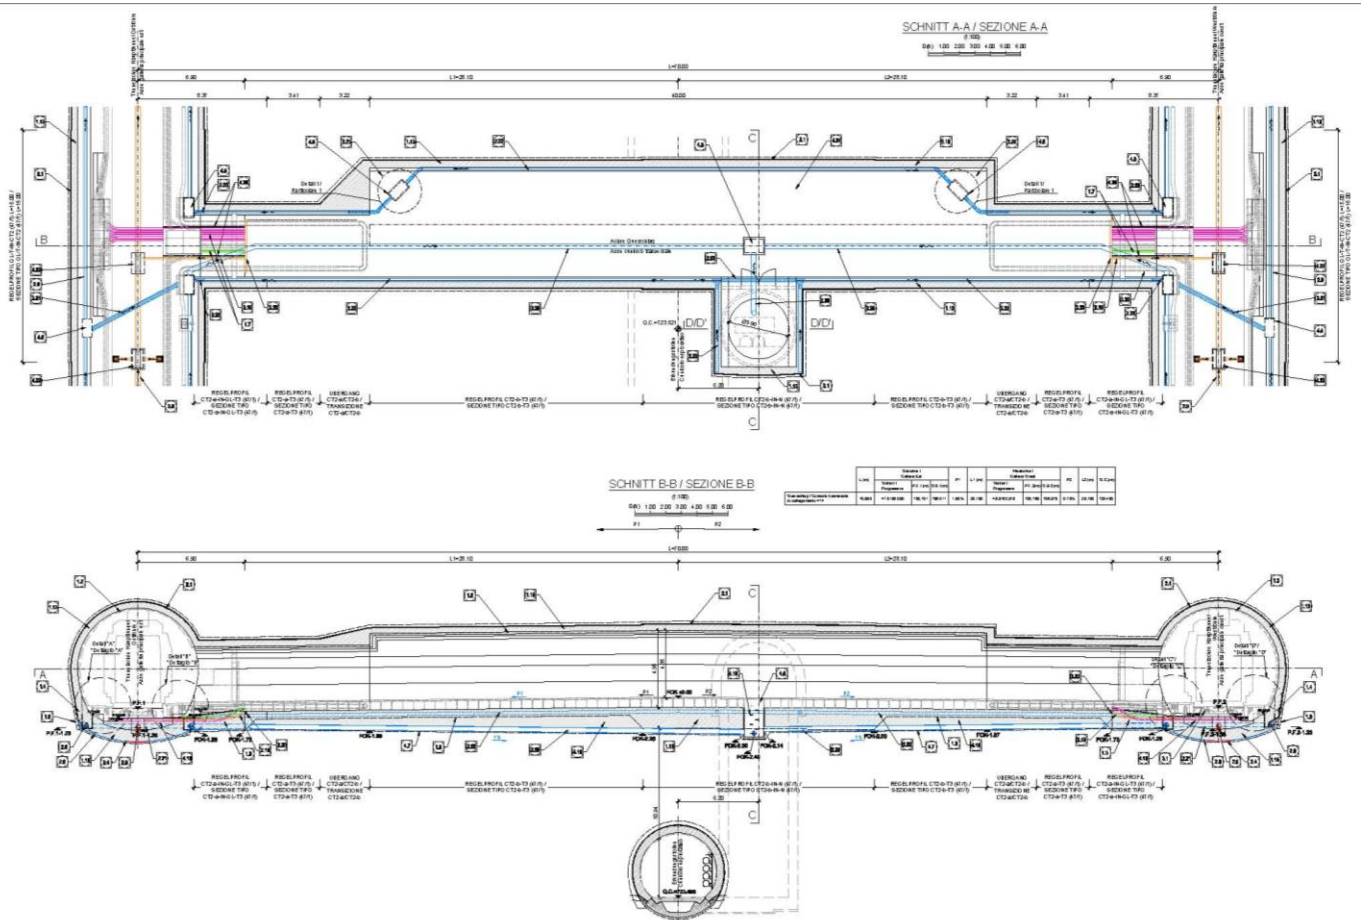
Querstollen Typ 2 (BP 47/1) - Grundriss und Längsschnitt [30].
